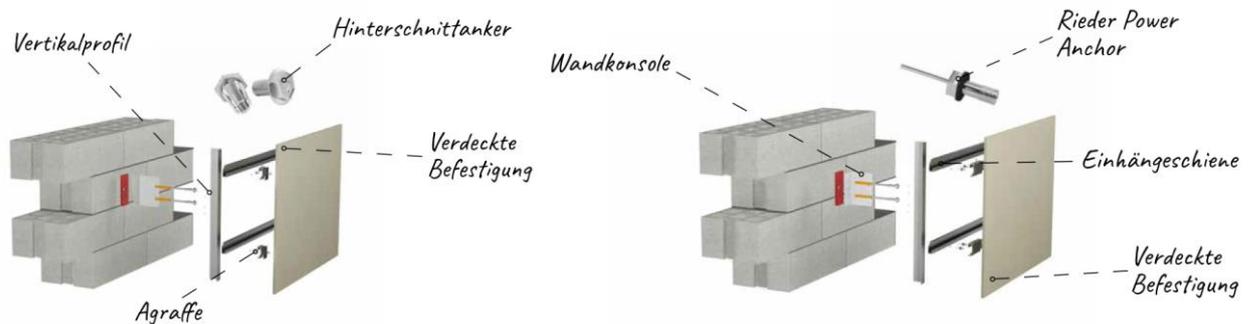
Befestigung mit Hinterschnittankern (links) und mit Rieder Power Anchor (rechts) [9]
